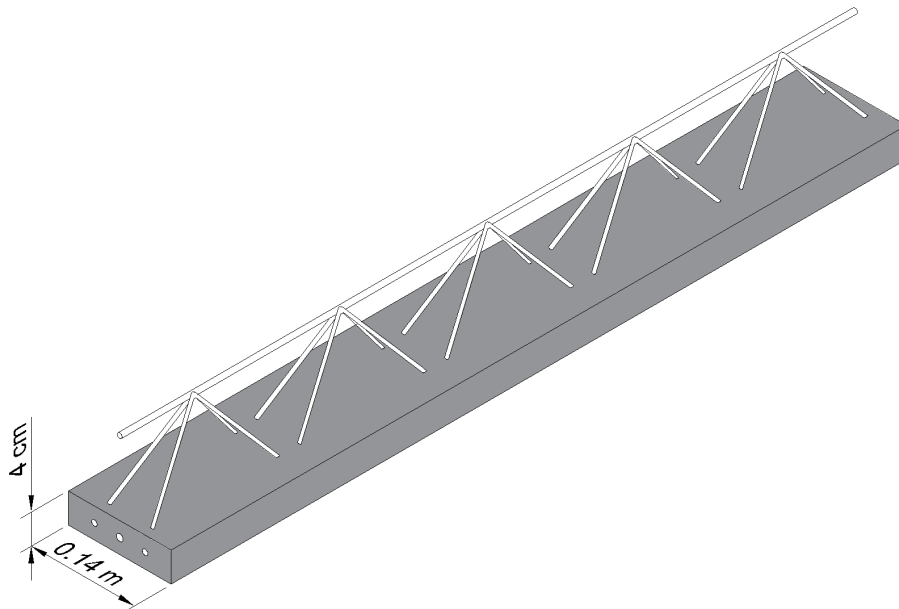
Detalle del Patín de Concreto de la Vigueta Alitec.
